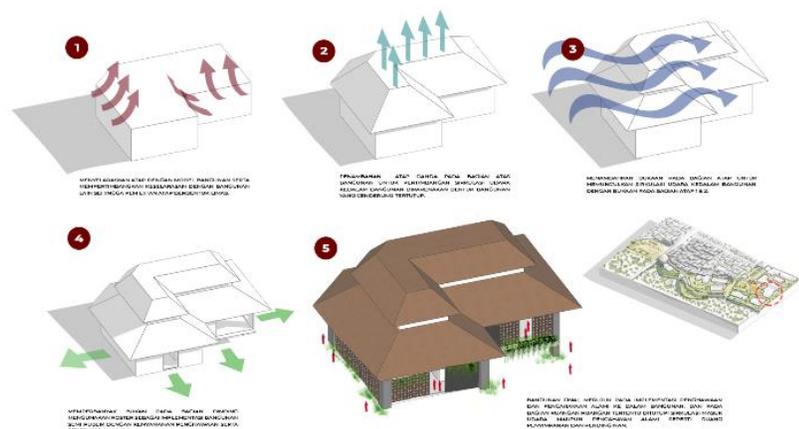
23 Bentuk Bangunan Greenhouse
